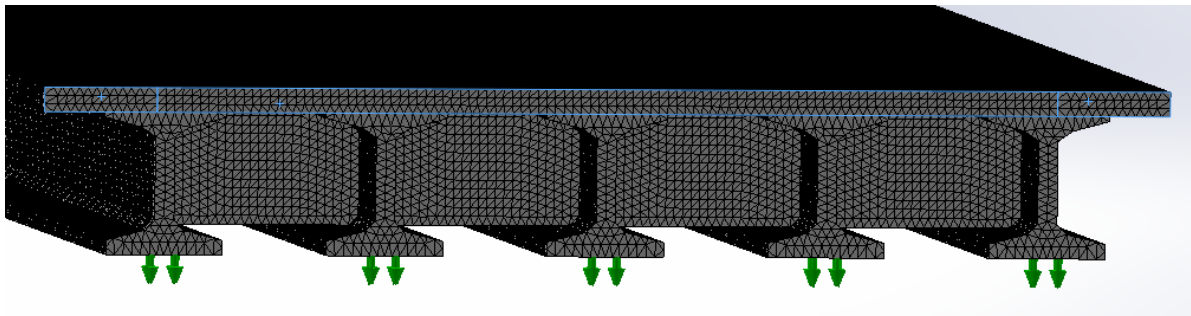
Vista de detalle de la parte frontal de un puente de 5 vigas tipo D con el tablero resaltado, SolidWorks.
